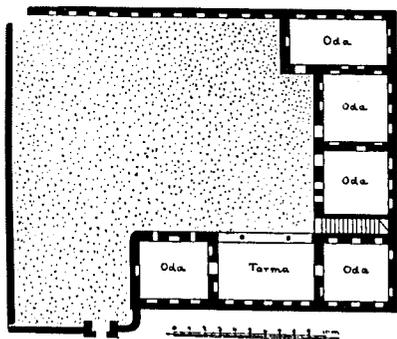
Haus des Abûd el Tschâli, Koweiresch. Grundriß.
